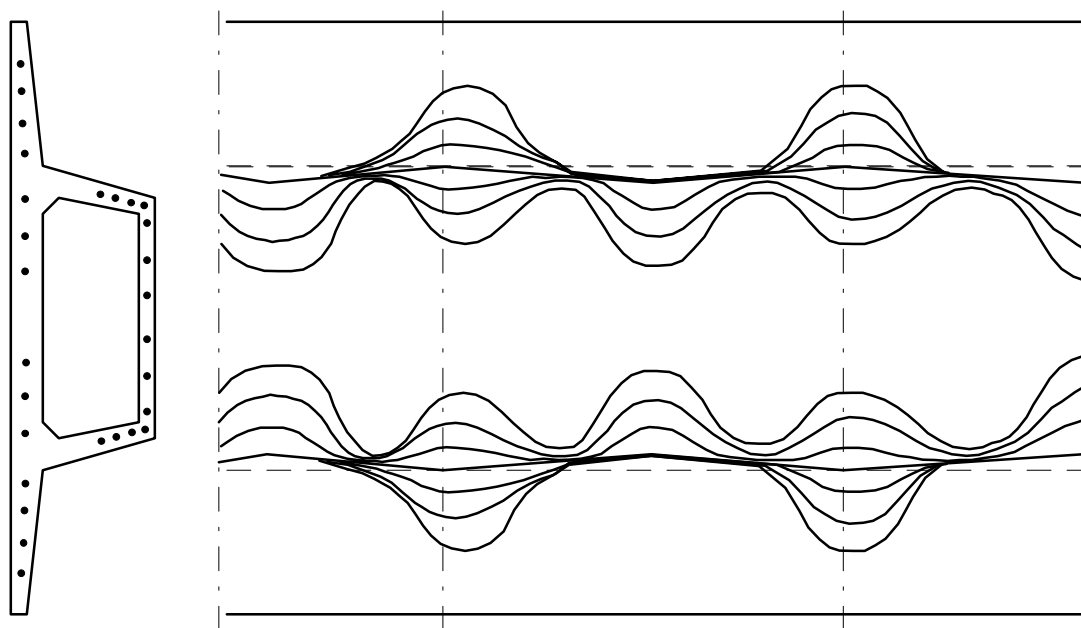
Planta dos cabos numa viga-caixão (as larguras estão exageradas!) (Bruggeling, 1991).
